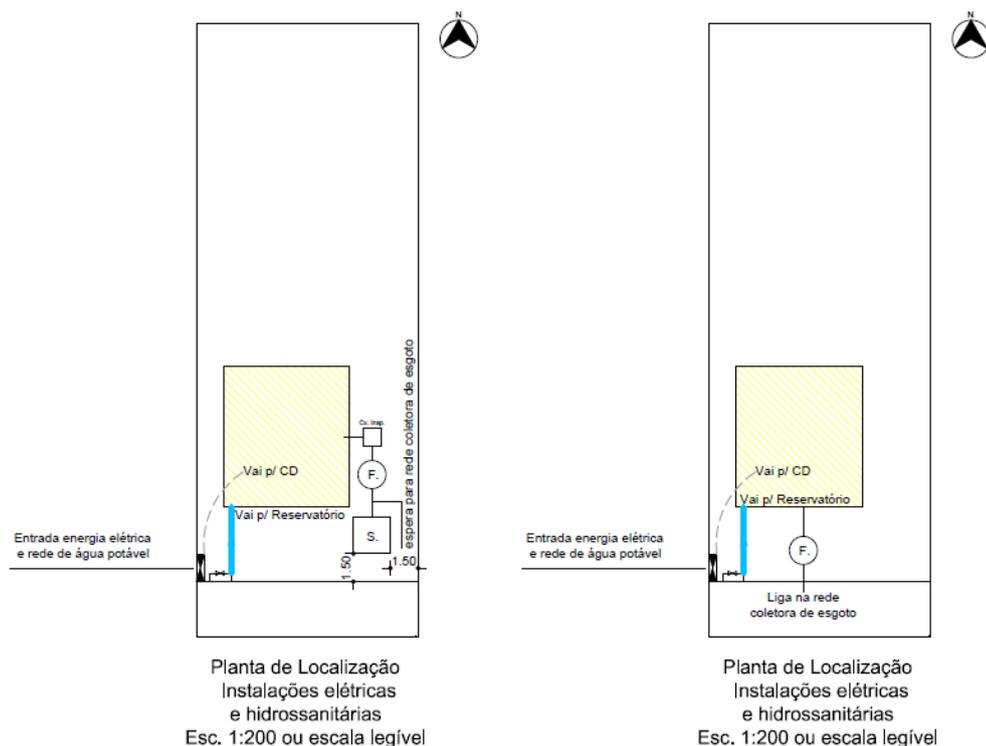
Croquis demonstrativos da planta de Localização das Implantações Elétricas e Hidrossanitárias
